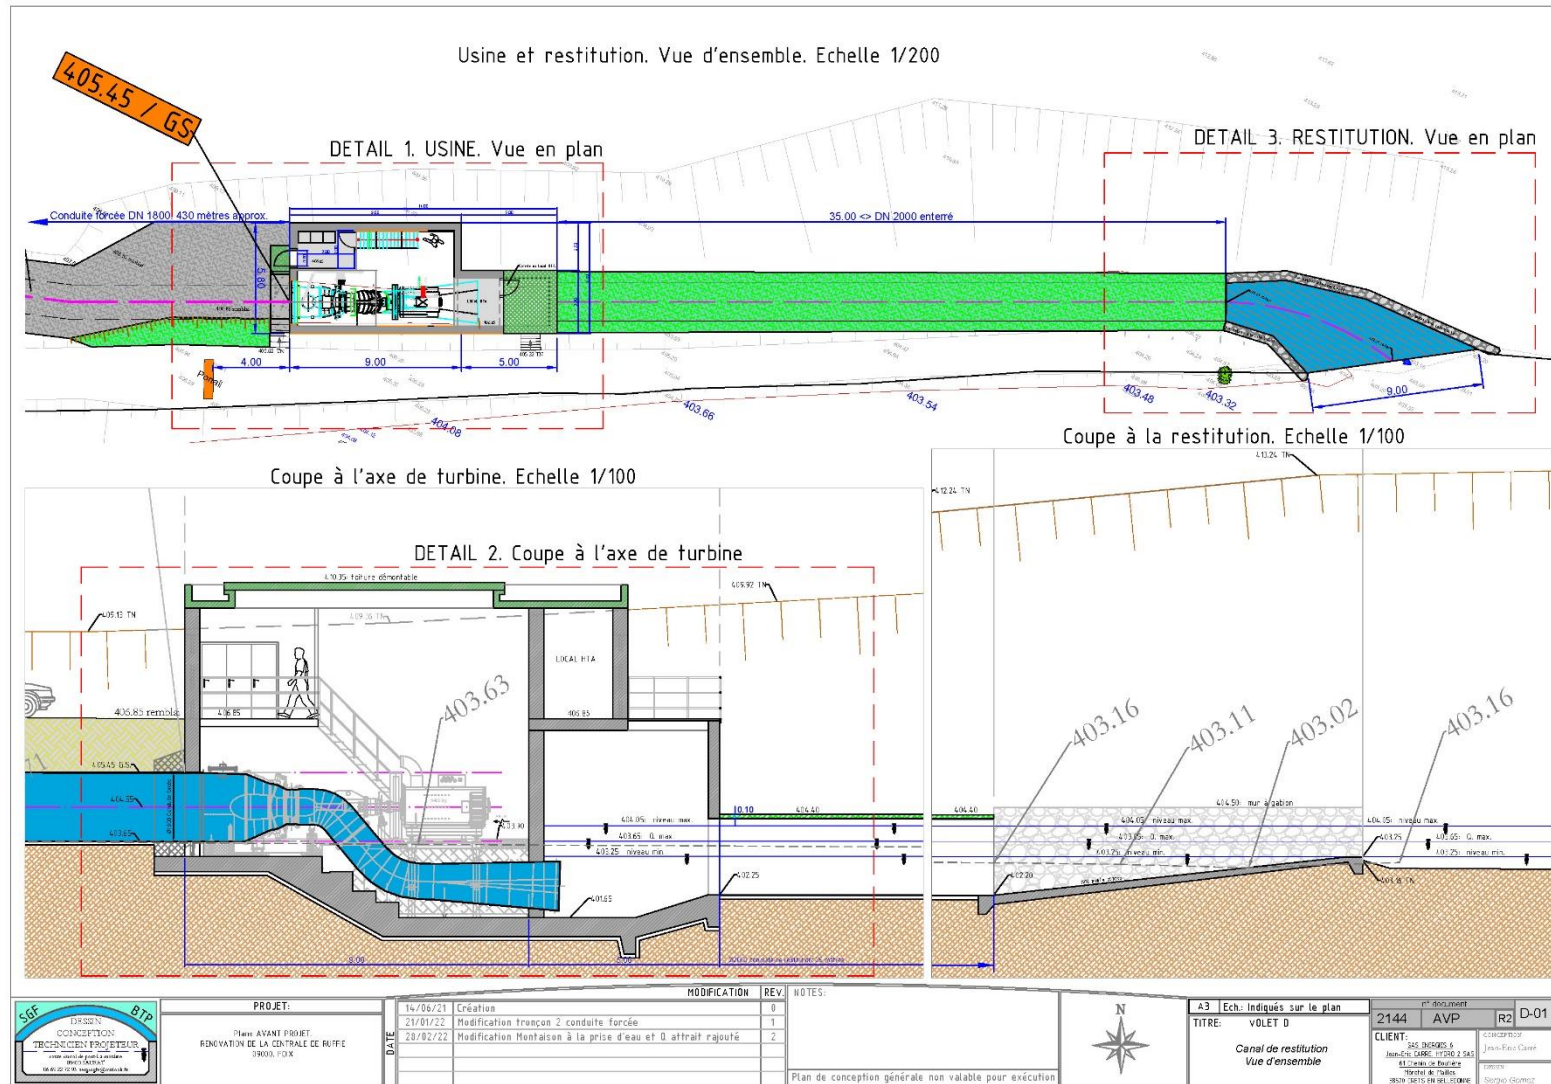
Dessin technique vue d'ensemble de l'usine et restitution
